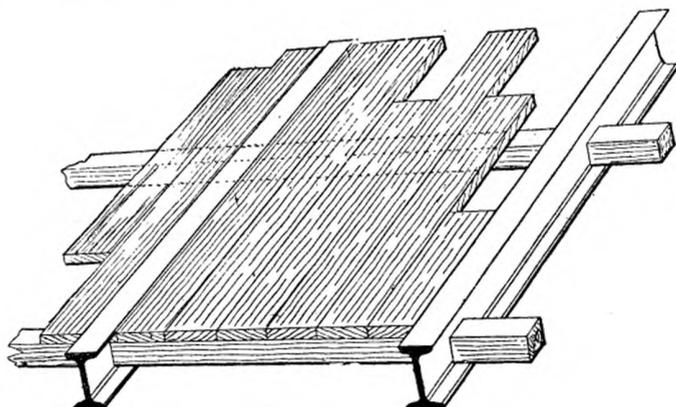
Cintre provisoire en bois reposant sur des poutrelles en acier.
